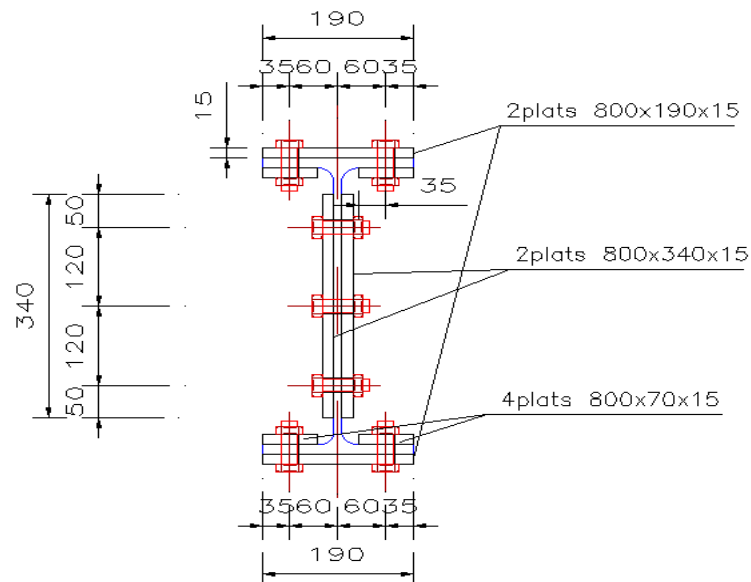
Détail de l'assemblage Assemblage poutre-poutre
